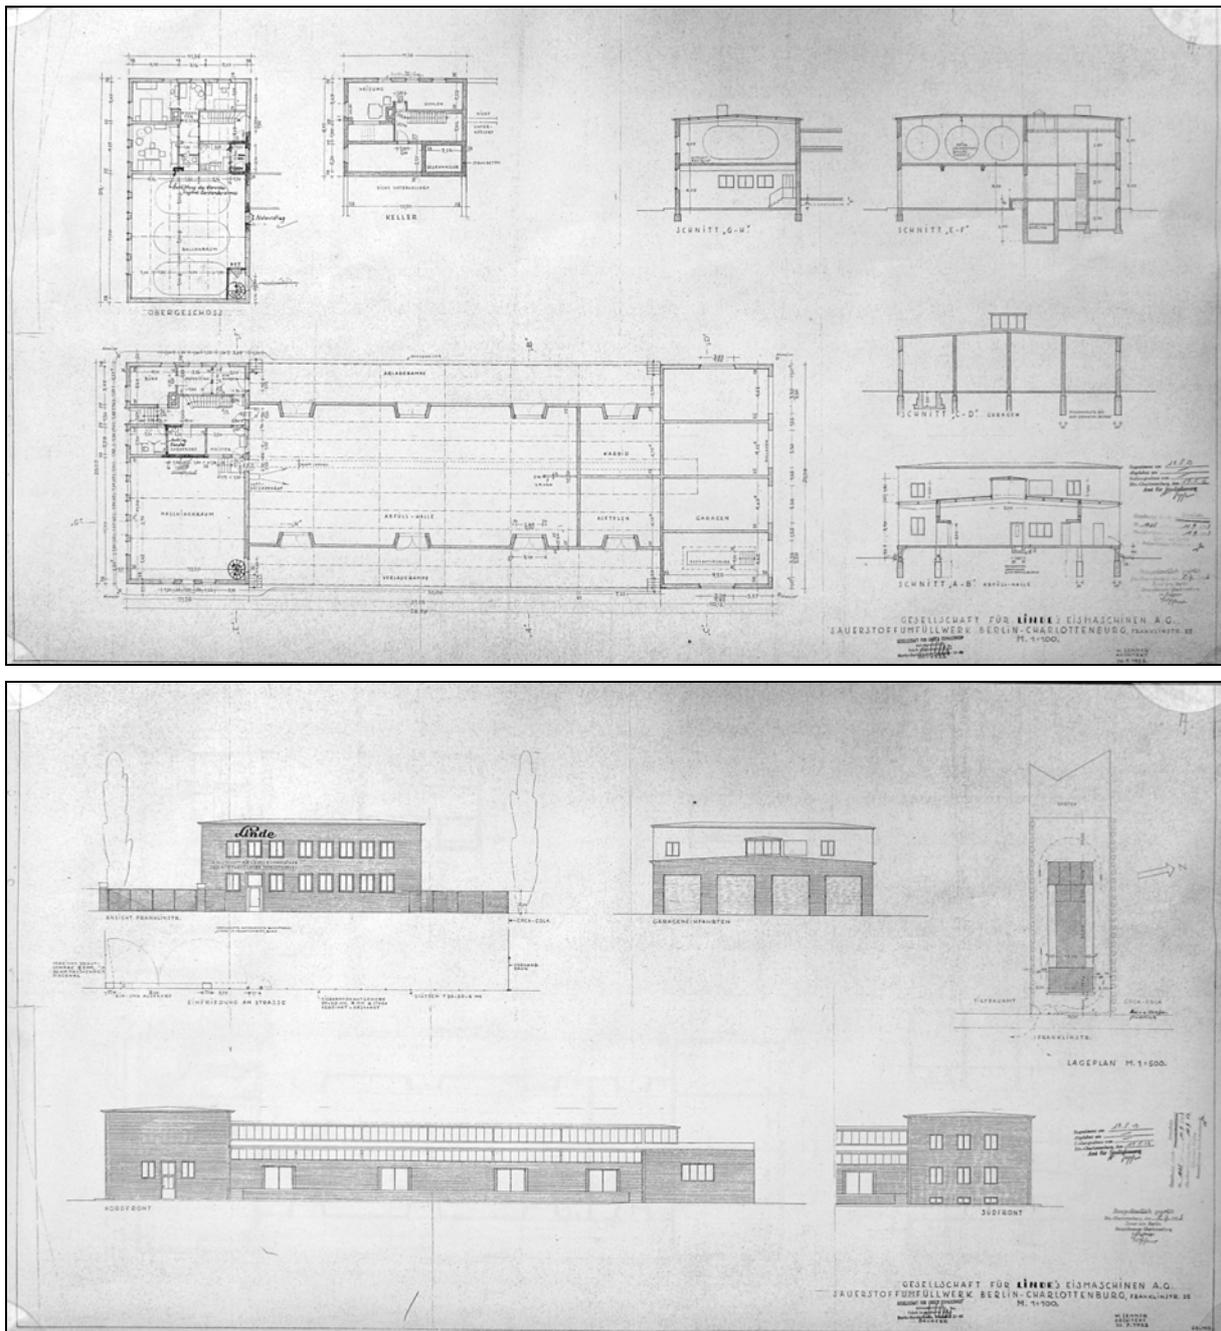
/3: Entwurfszeichnungen für den Bauantrag, Grundrisse, Schnitte, Ansichten. Architekt Walter Semmer 26. Juli 1953
